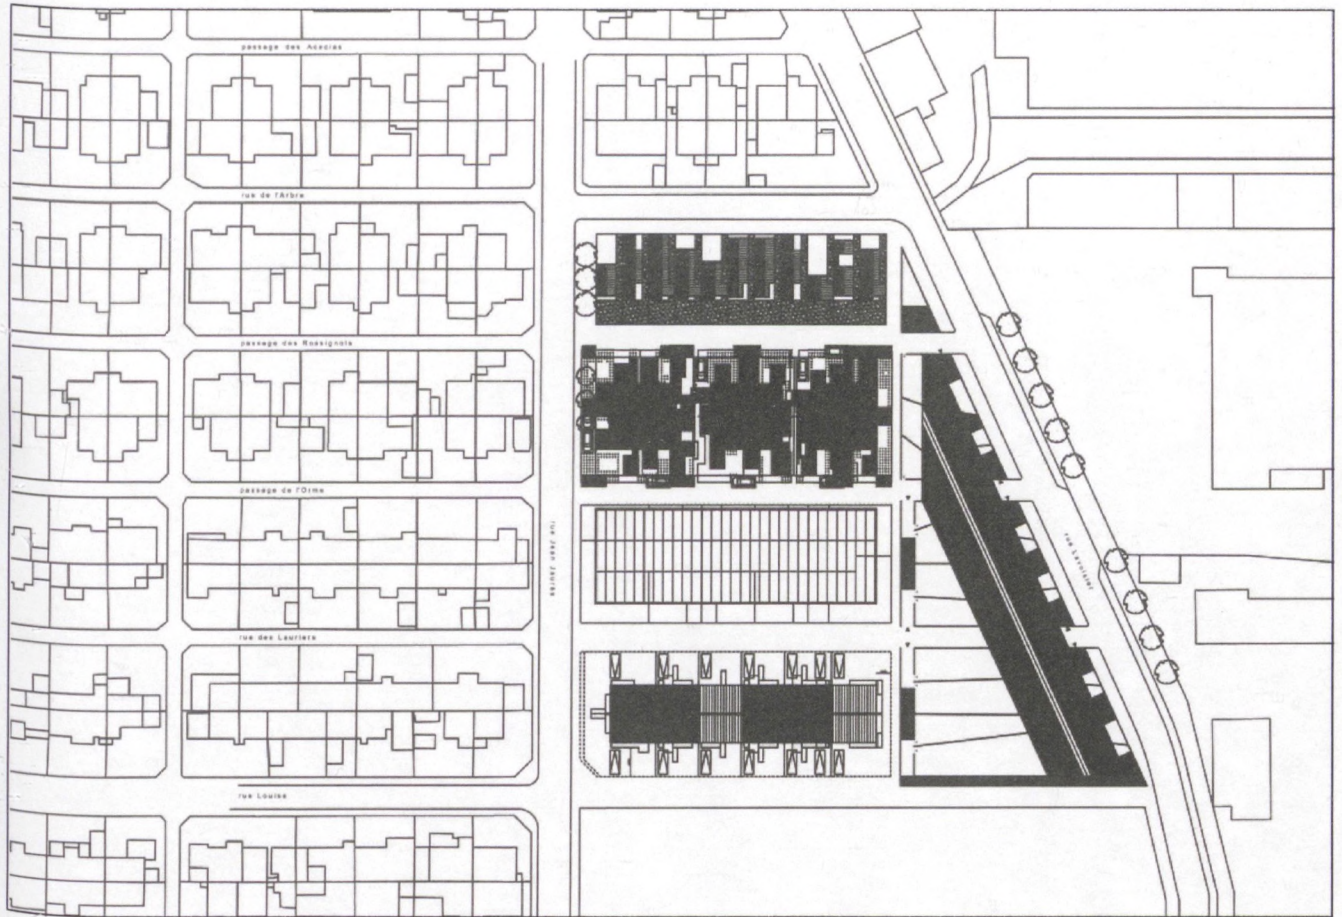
Plan masse, Cité Manifeste, Mulhouse. Source : SOMCO
